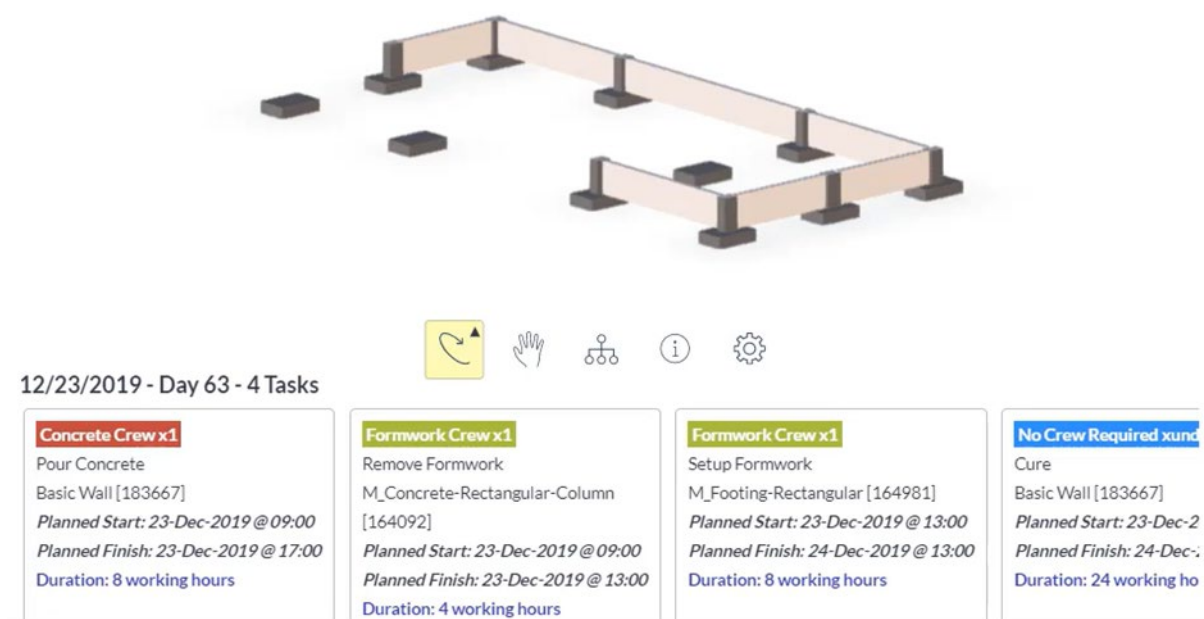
Recept za izgradnju betonske konstrukcije[2]
